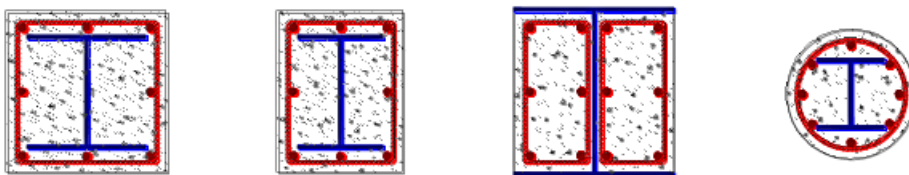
Miembros Compuestos de Perfiles de Acero embebidos en hormigón armado
